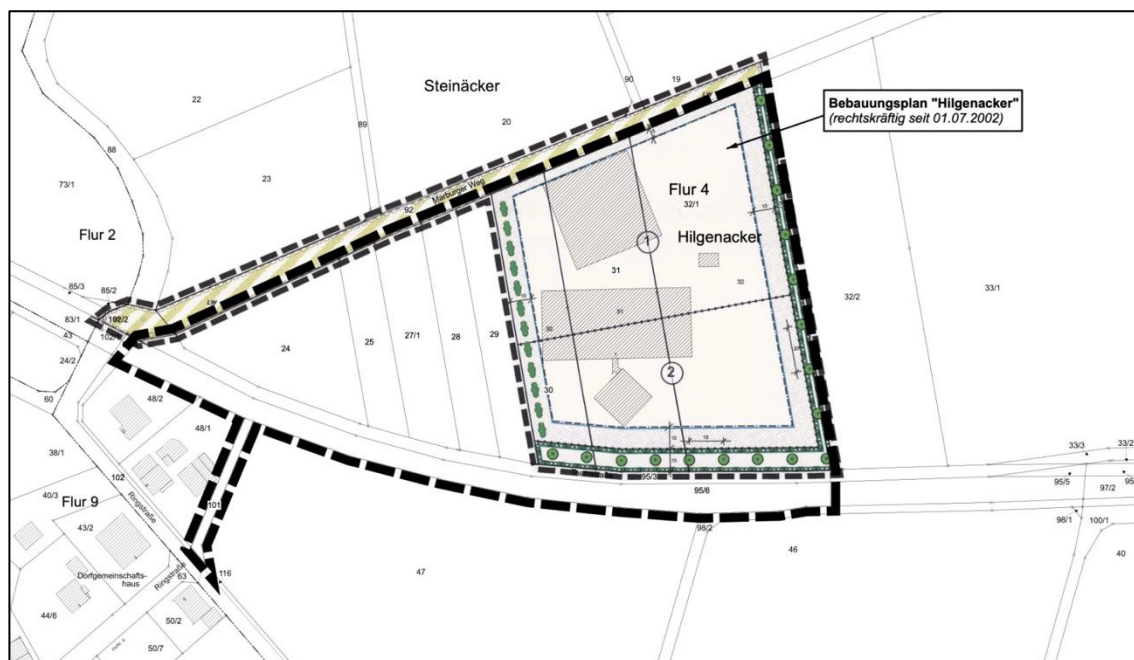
Plangebiet und Ursprungsbebauungsplan
